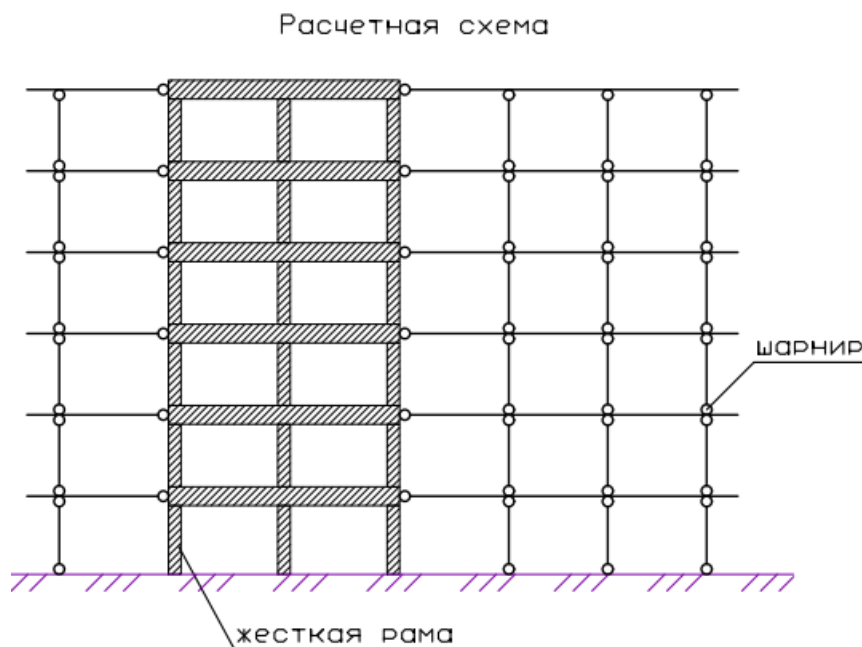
Расчетная схема с жесткой рамой и плоскими перекрытиями
